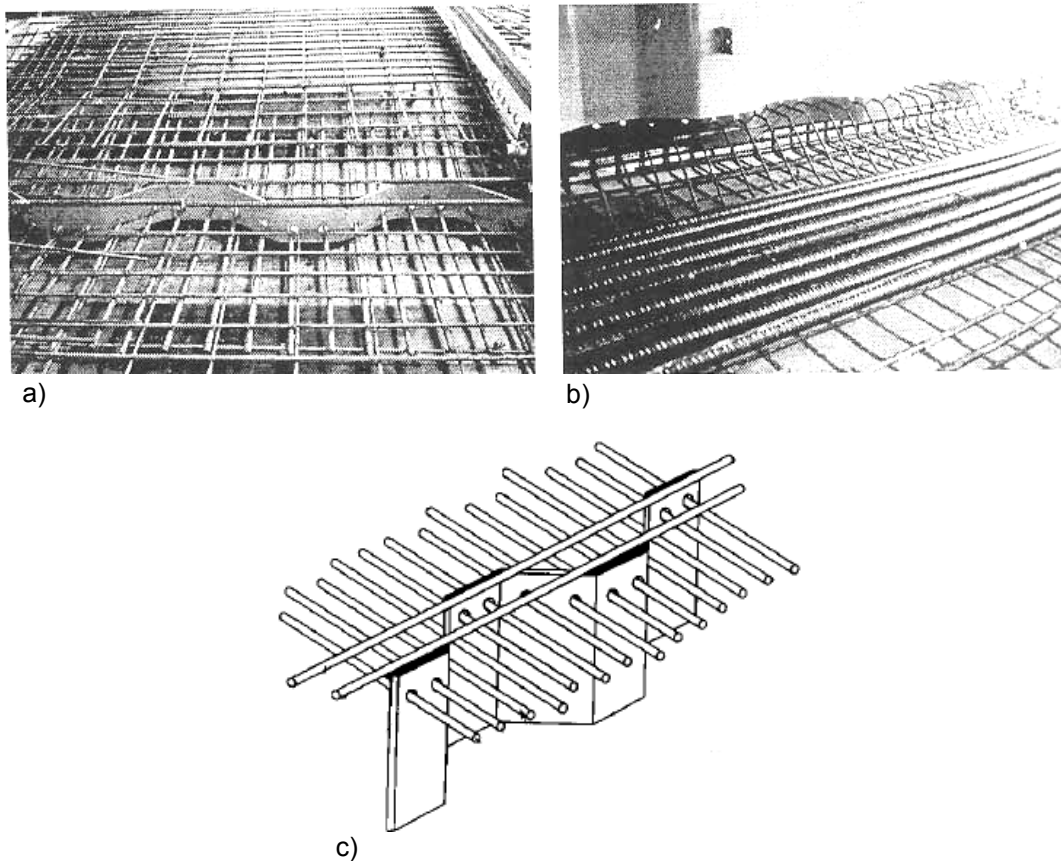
a) Verbundfuge der Hondani-Brücke am oberen Flansch
